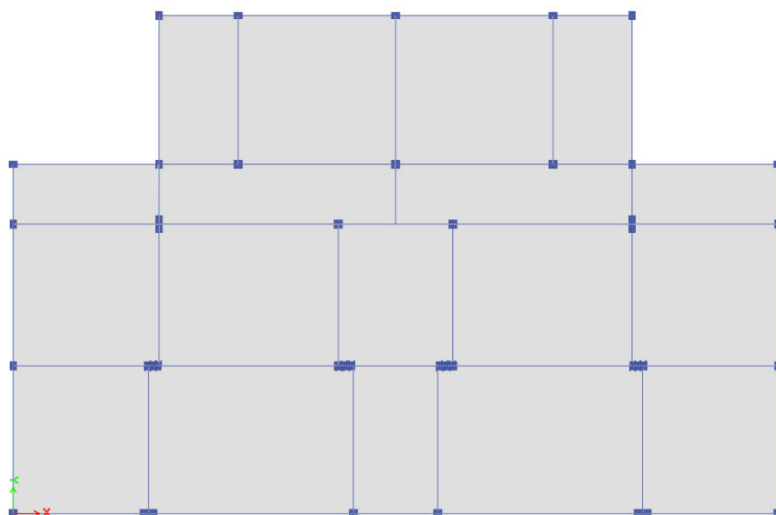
Planta tipo do edifício em estudo - *ETABS
